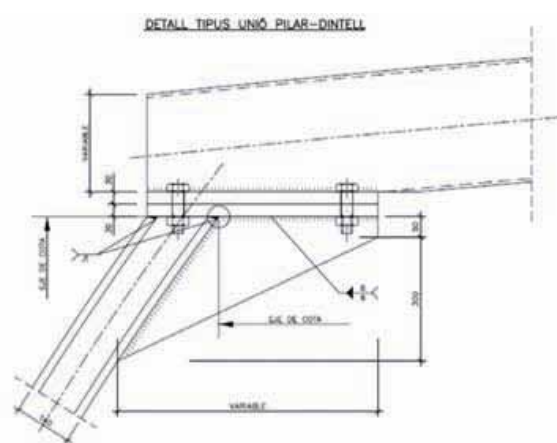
Detalle de la unión pilar-dintel del forjado mixto ligero.
